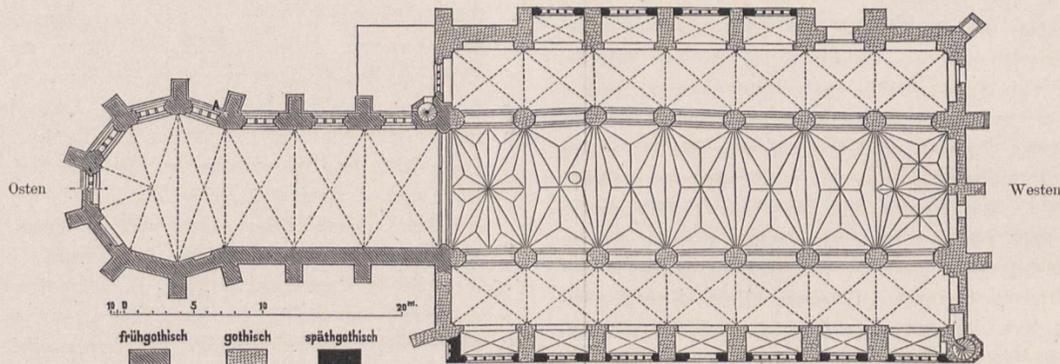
Grundriss der St. Johanneskirche in Stettin.
